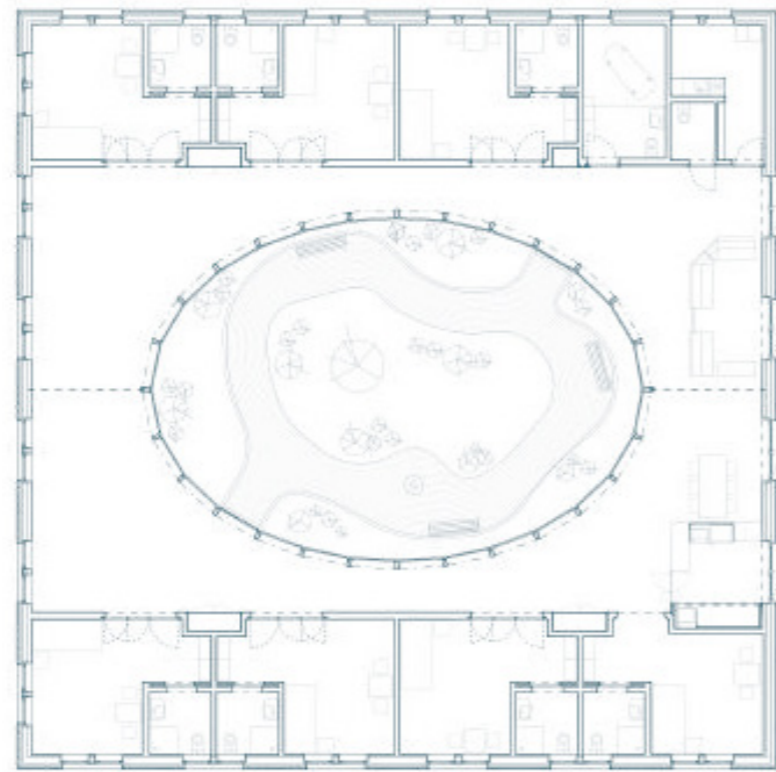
Pianta piano terra (© Vincenzo Cangemi Architekten)
